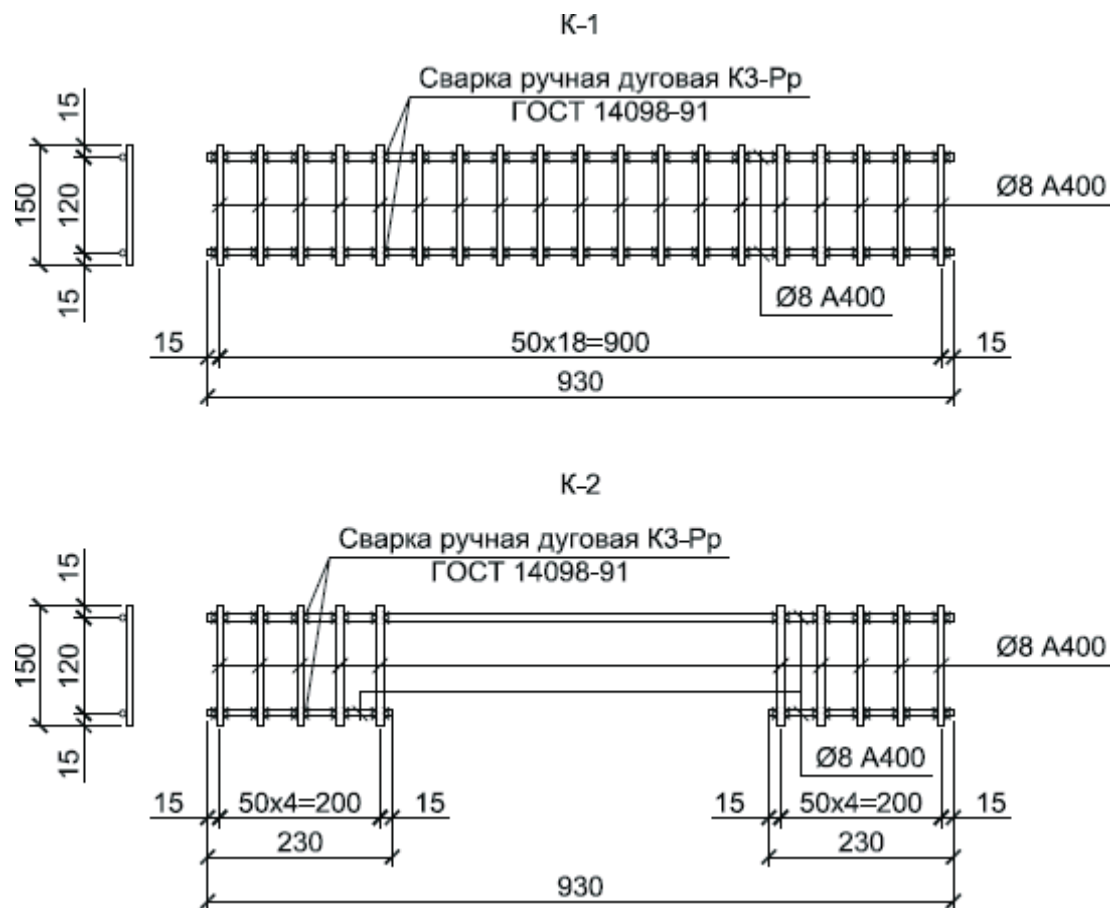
Общий вид каркасов дополнительного армирования плиты перекрытия в зонах продавливания
